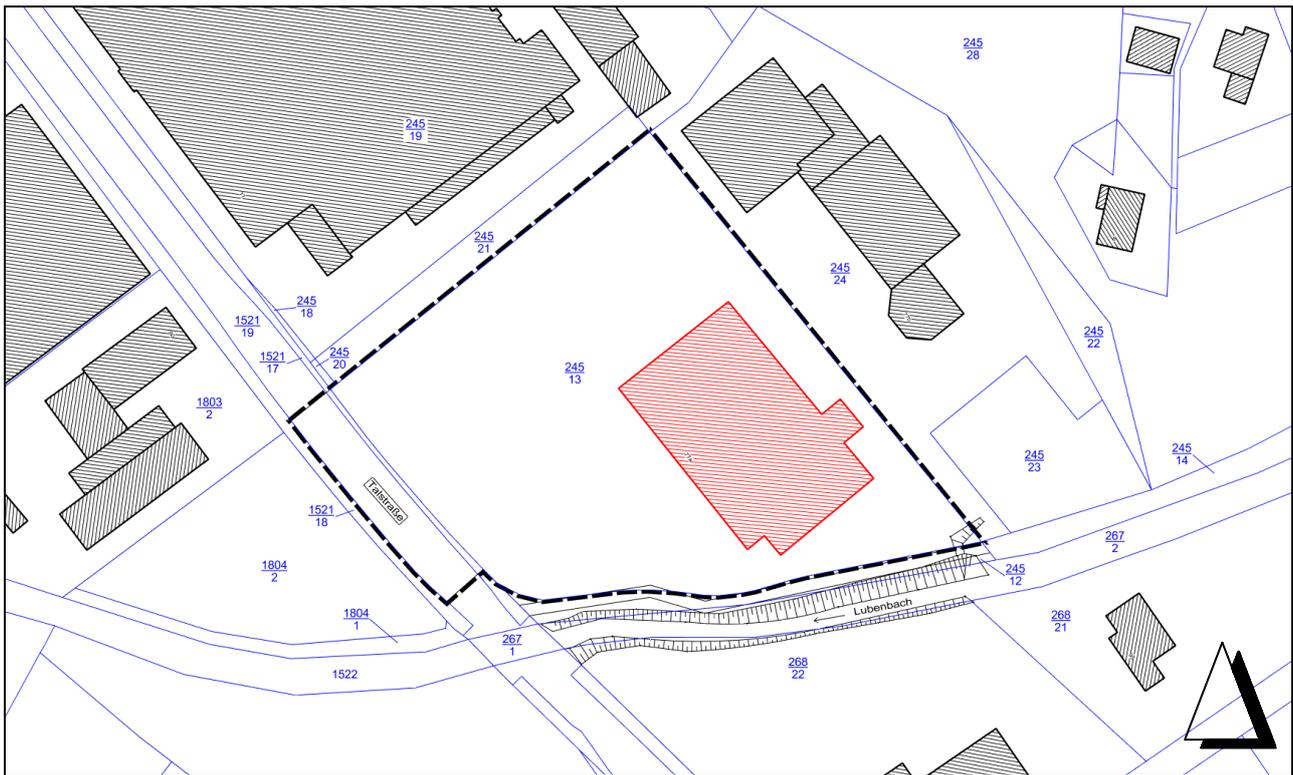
Lageplan mit Darstellung der zurückzubauenden Gebäude (rot)
